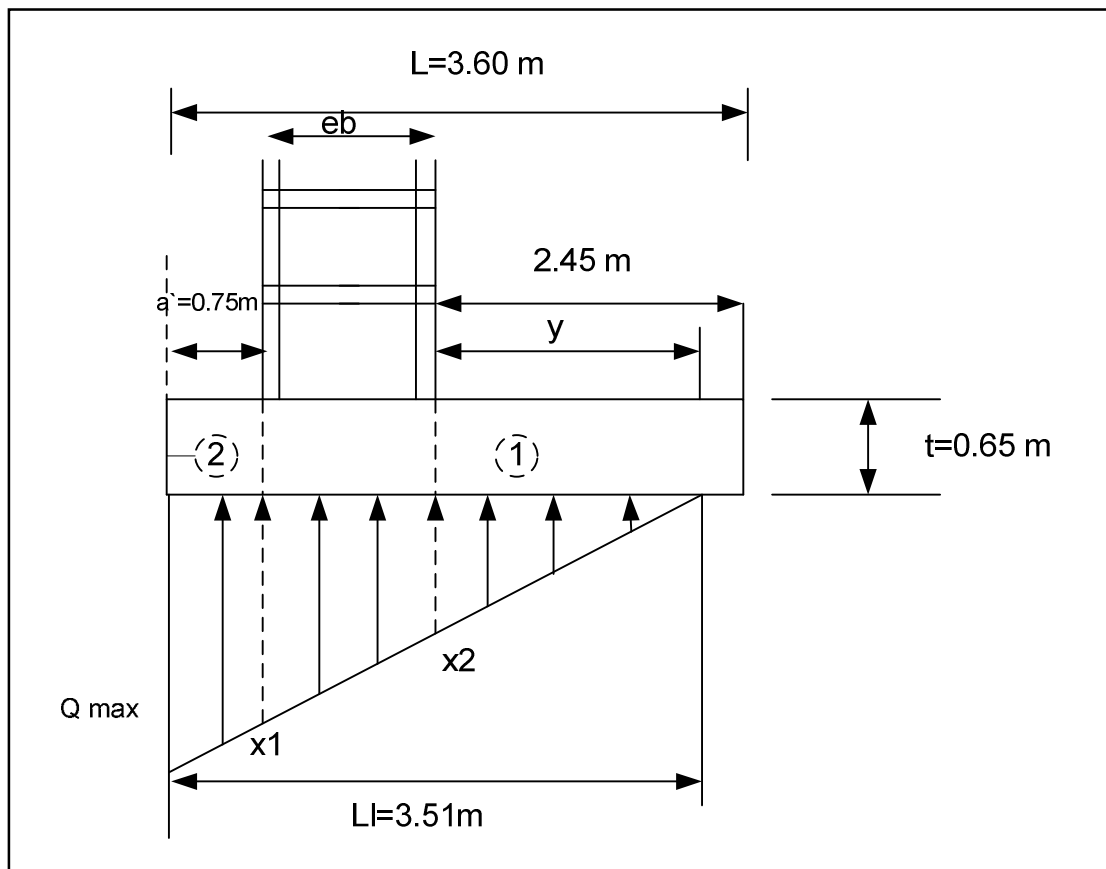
Placa de cimentación de muro de retención de mampostería reforzada de 4m
